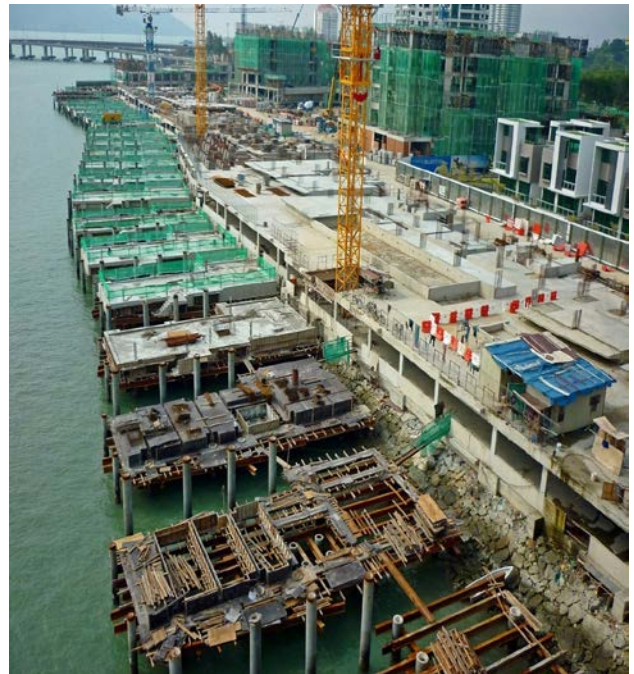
Fasa Pembinaan Projek The Light Water Front Penang
